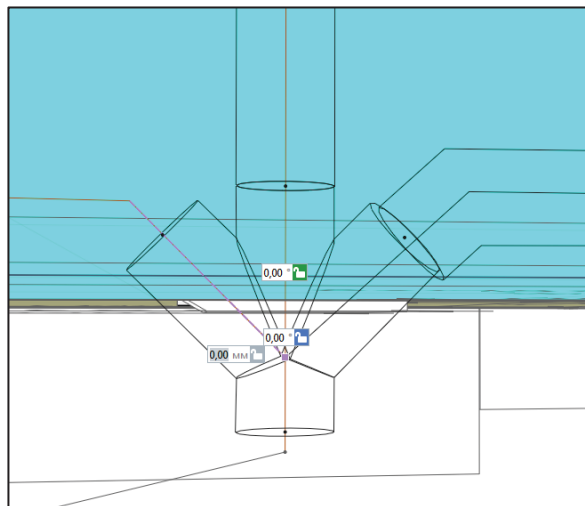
Установление осей примыкания двух трубопроводов к стояку под углом 45°
